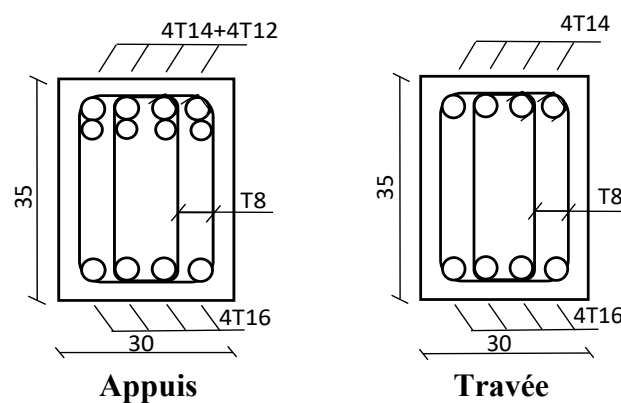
Schéma de ferraillage des poutres non porteuses.
